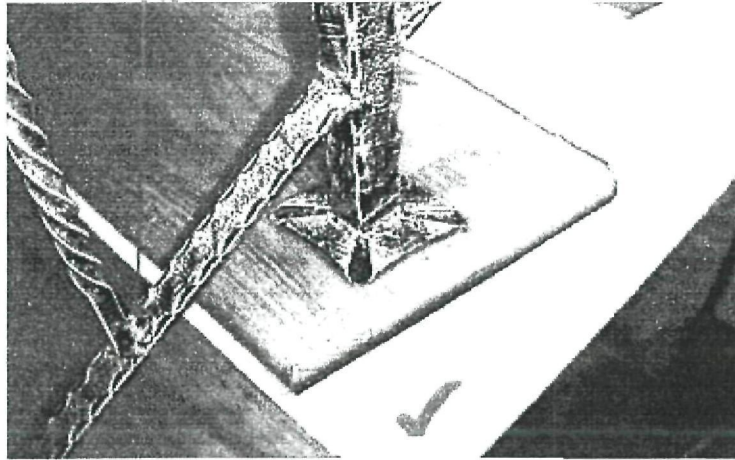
Penyambungan kimpalan pada "handrail"
